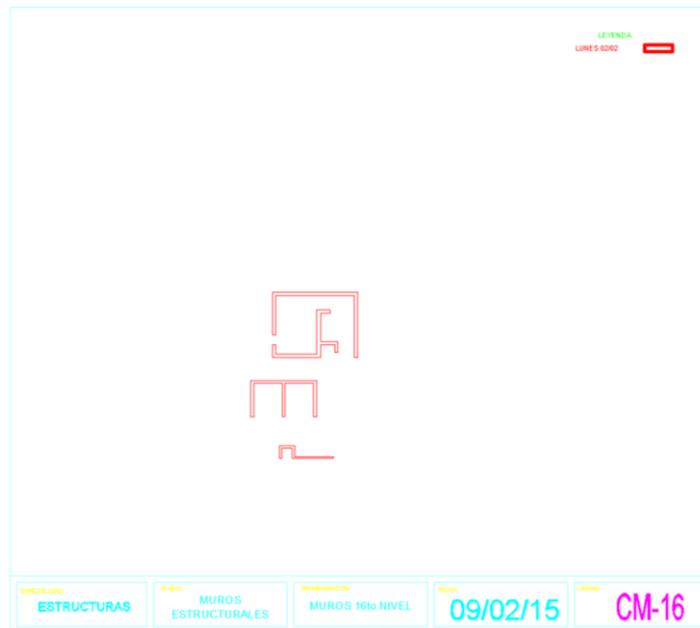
Sectorización de Muros Nivel 16. Fuente: Elaboración Propia
